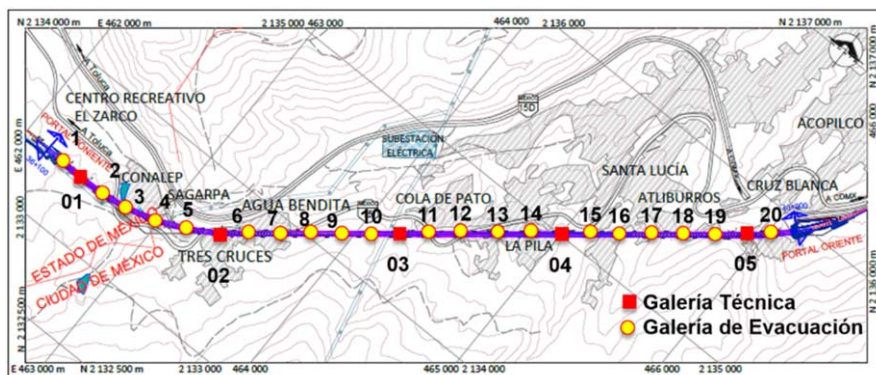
Planta de localización del bitúnel proyecto TIMT.
